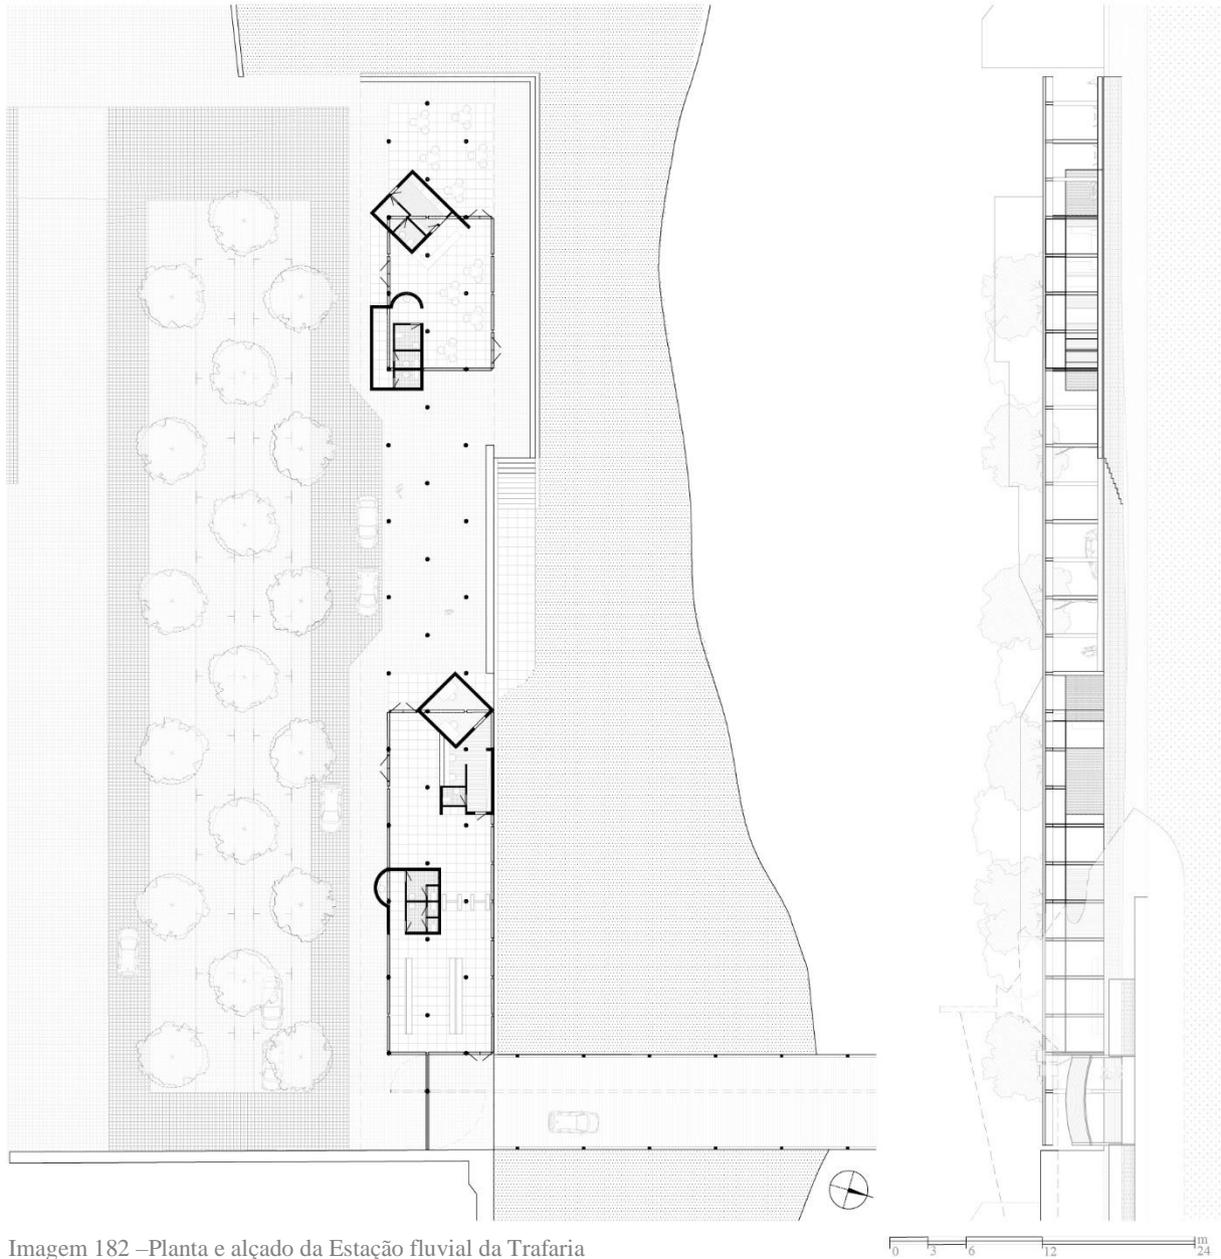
Planta e alçado da Estação fluvial da Trafaria
